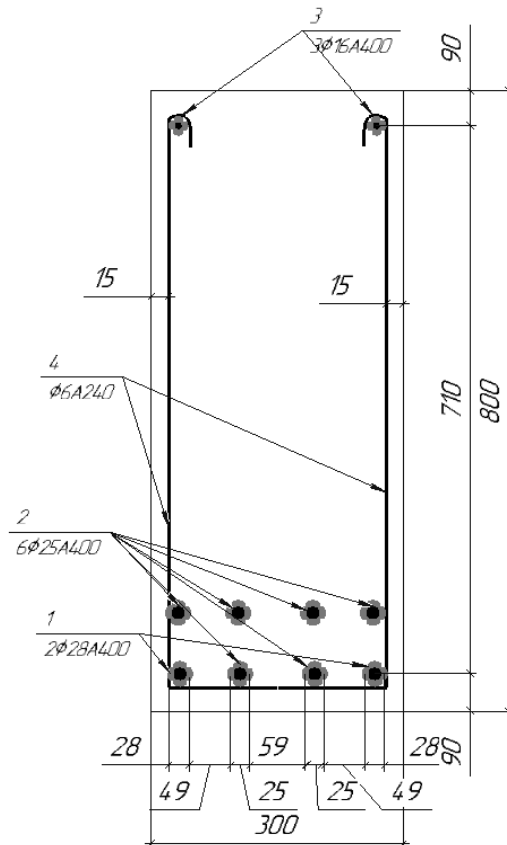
Конструювання нормального перерізу залізобетонної балки з подвійним армуванням
